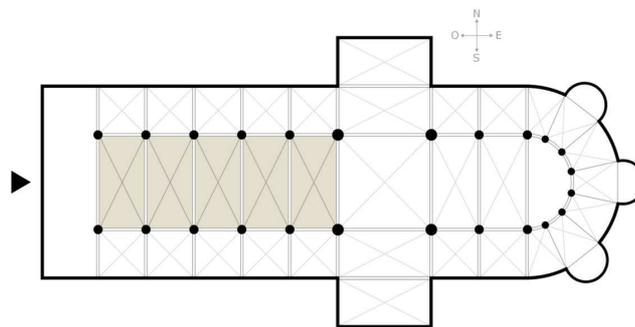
Plan chapelle Saint-Luc Vaisseau central (en bleu)
